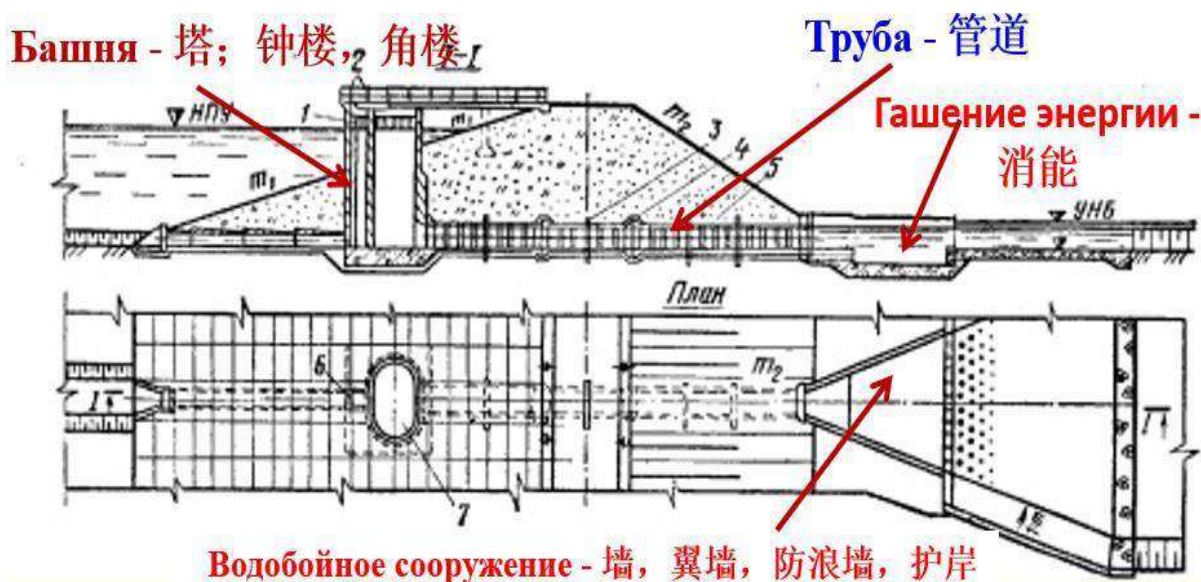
Продольный разрез и план типового проекта трубчатого нерегулируемого водосброса, Укргипроводхоз: 1 – сороудерживающая решётка; 2 – подъёмник; 3 – железобетонная диафрагма; 4 – деформационный шов; 5 – оклеечная гидроизоляция
